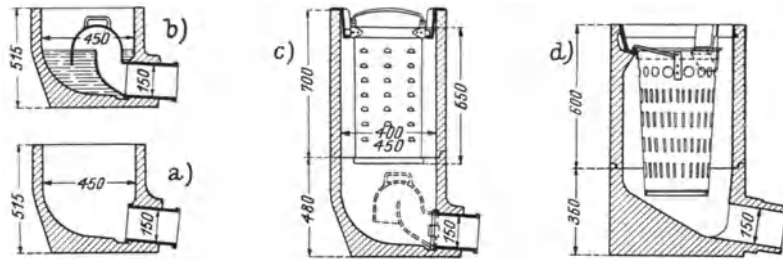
Straßenabläufe aus fabrikmäßig hergestellten Betonformstücken.
